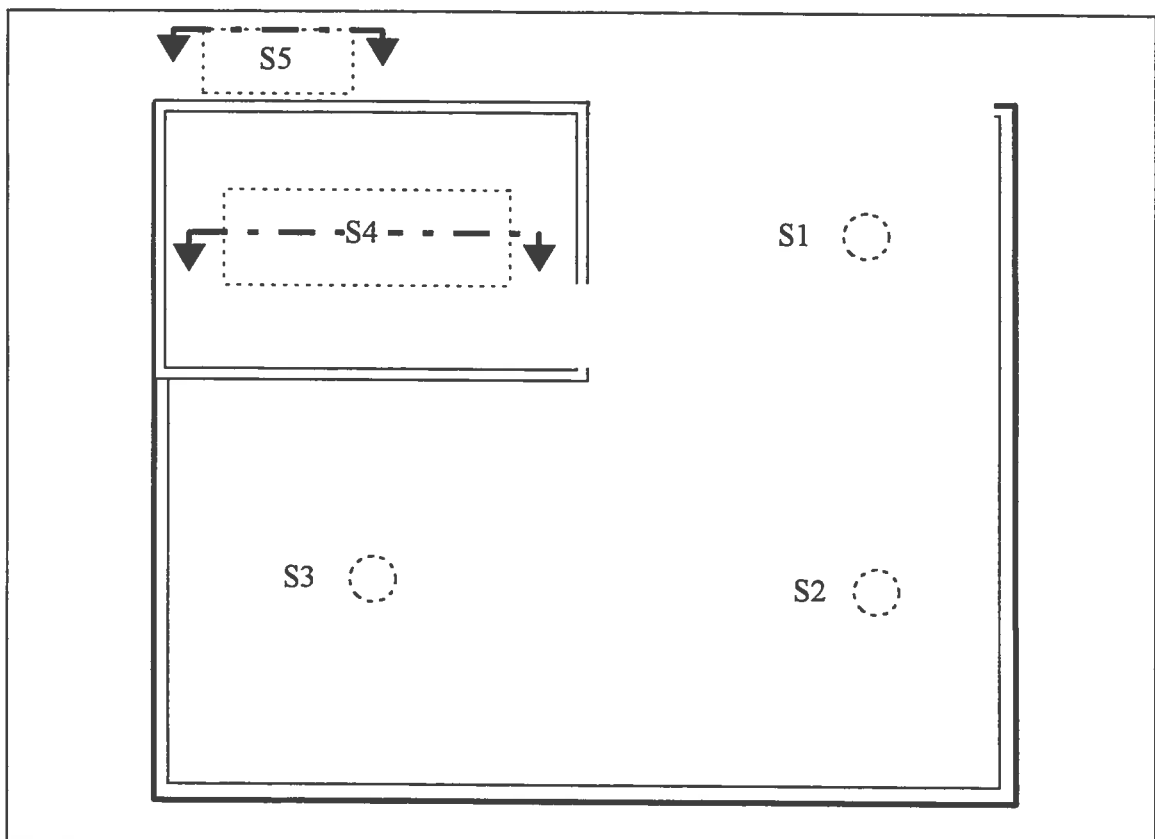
Plan de localisation des sondages à l'intérieur du bâtiment
